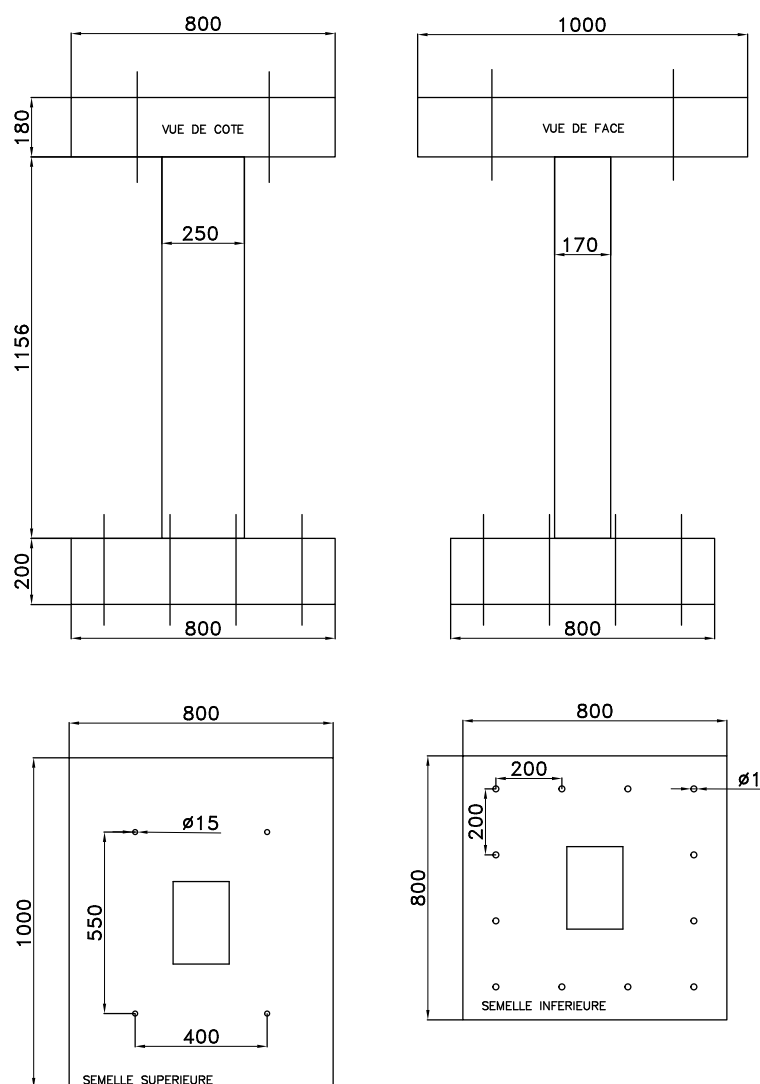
Poteau SIBA - Plan de coffrage - Dimension en mm.
